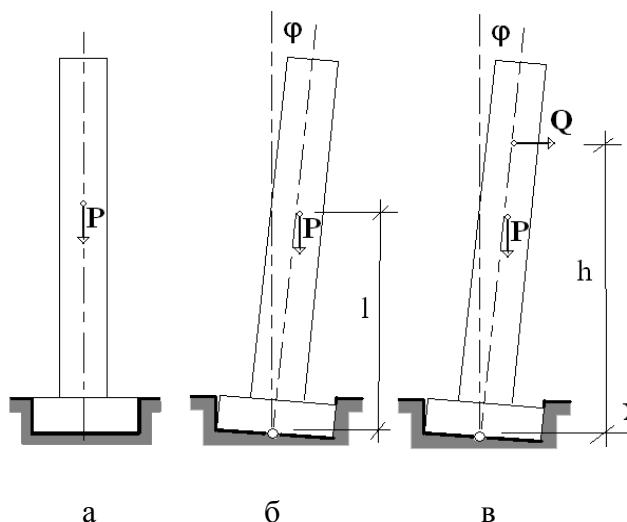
Расчетные схемы жесткого сооружения с фундаментом на грунтовом основании:
